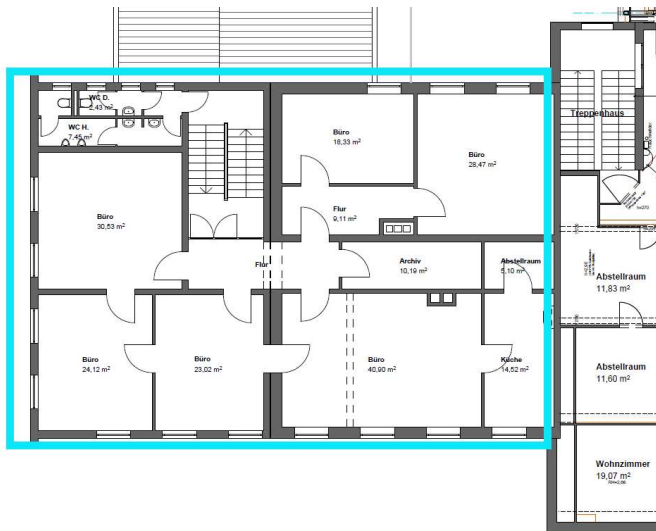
Rathaus Pullach, Grundriss DG, Neuer Rathausabschnitt
